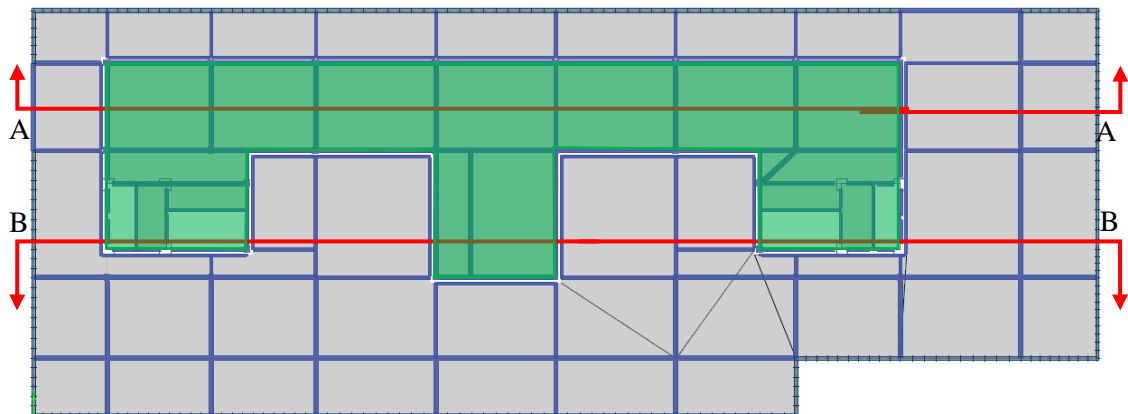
Vista en planta de ubicación de aulas (verde) y Sótanos (Azul).
